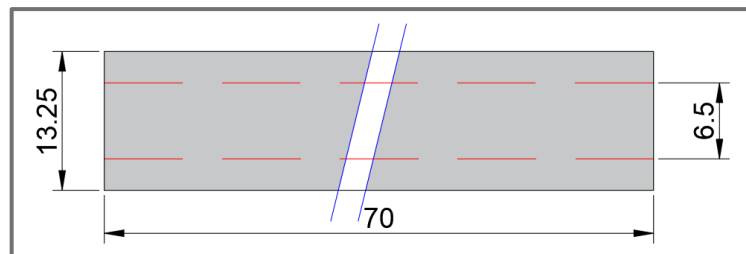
Vue en plan de la dalle de la Travée de rive
